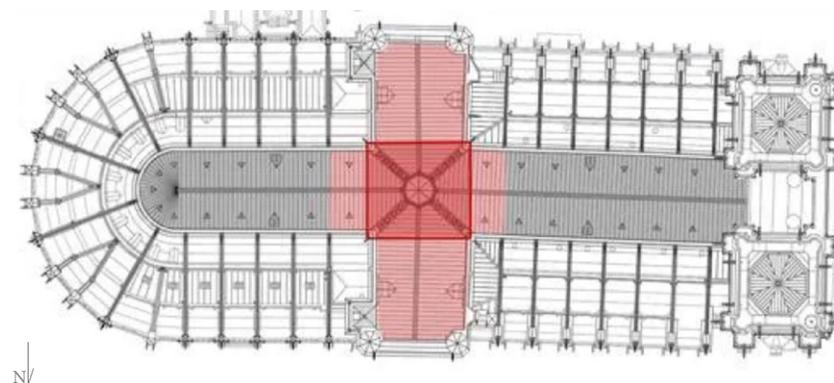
Levantamiento planimétrico de la *Forêt* por Remi Fromont y Cédric Trentesaux (Fuente: <https://www.albanecar.es>).
